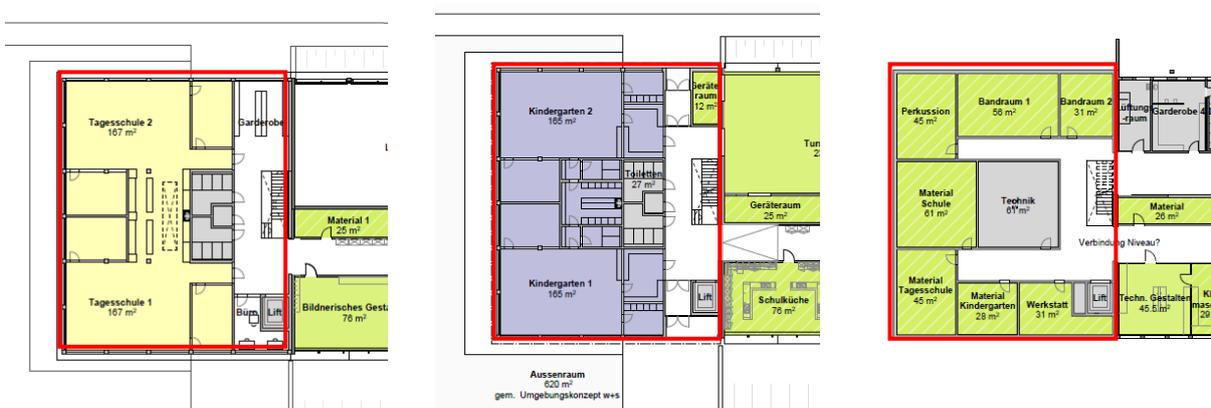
Grundrisse OG / EG / UG der geplanten Erweiterung
